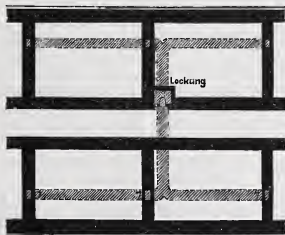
Grundriss vom Keller-Geschoß.
